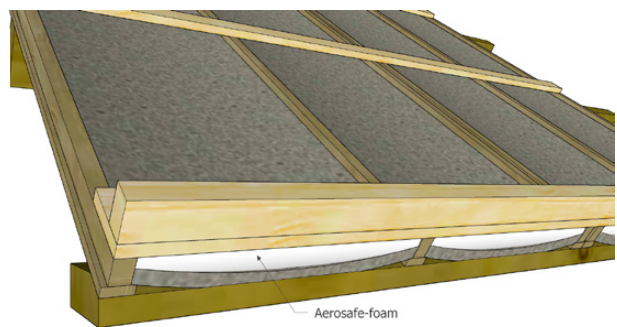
Voorbereiding bij doorbuigend dakbeschoot
